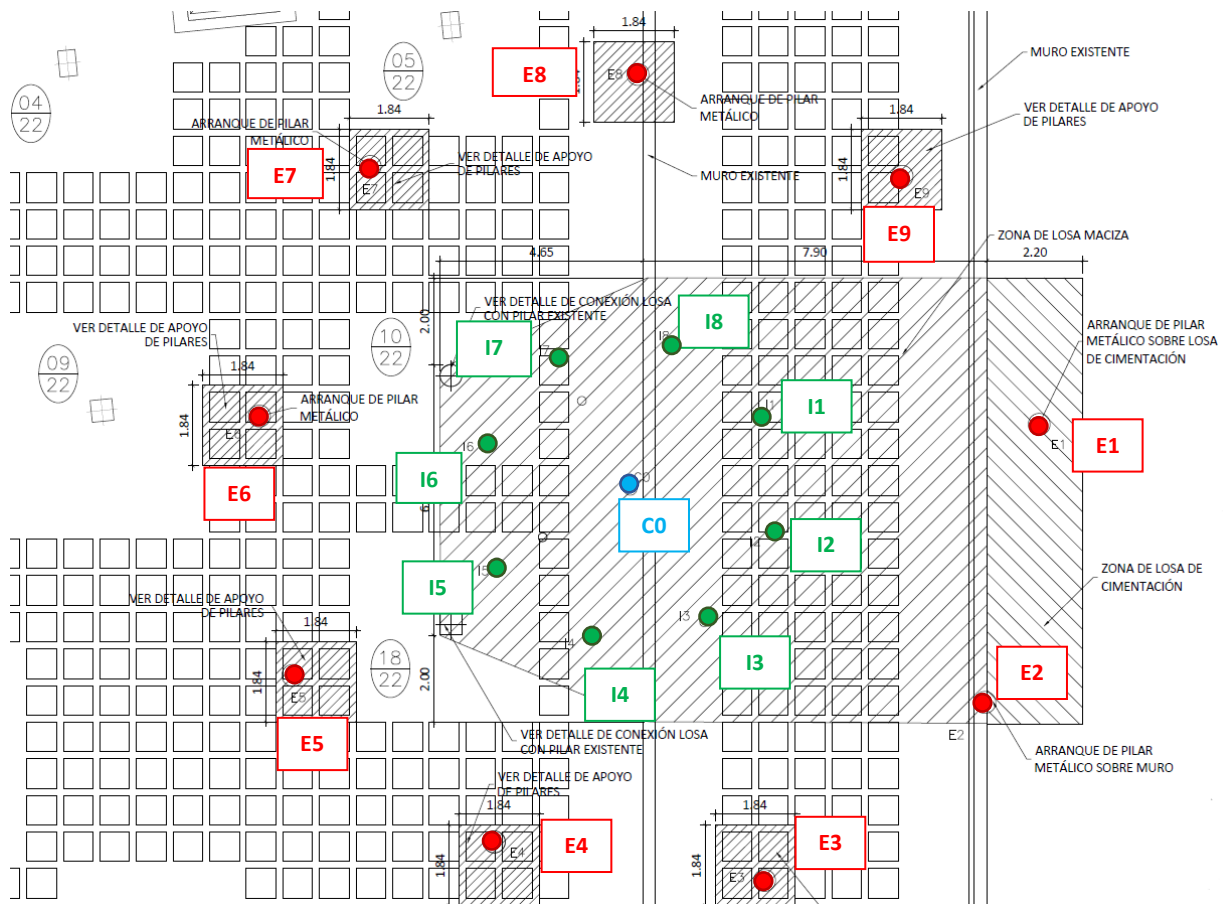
Planta general de la cimentación de la torre principal. Fuente: Proyecto instalación de parque Multiaventura sobre forjado del centro comercial LAGOH en Sevilla
